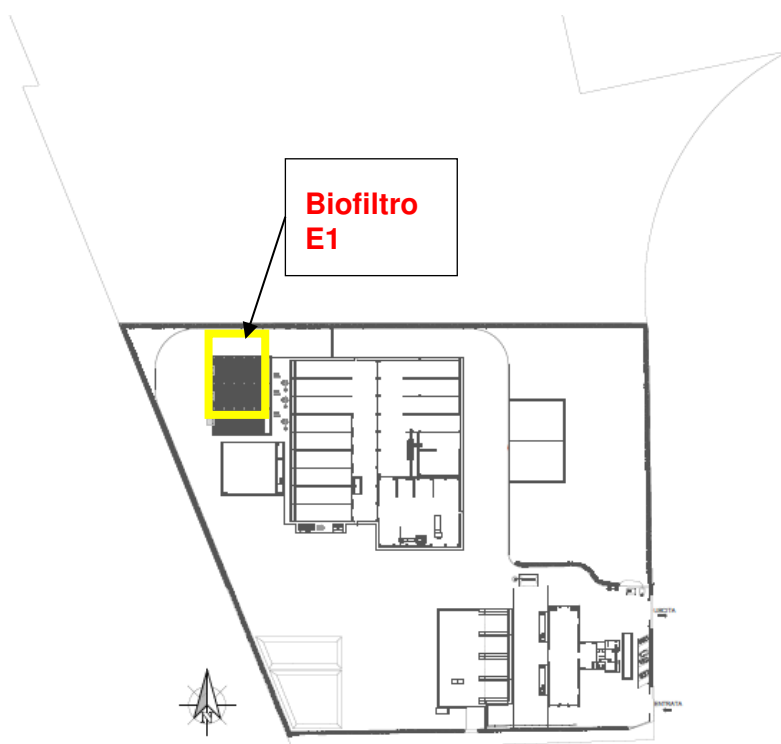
Planimetria generale impianto con individuazione delle sorgenti emissive interne
